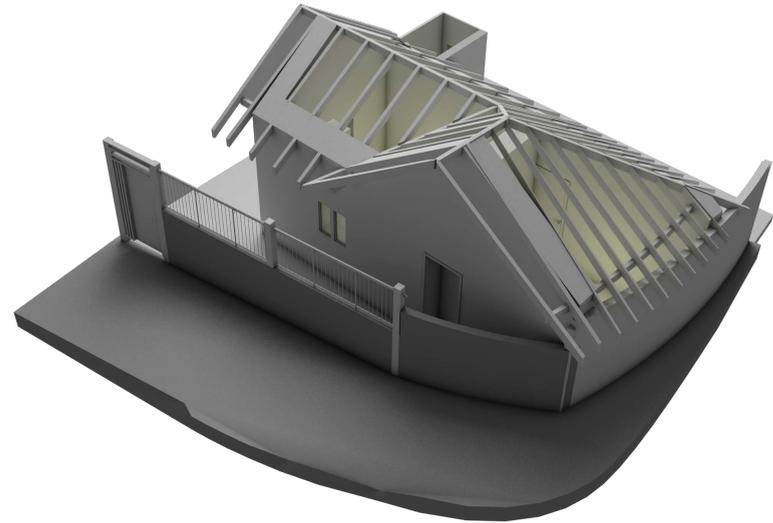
Modelo constructivo 3d de los soportes de la cubierta
